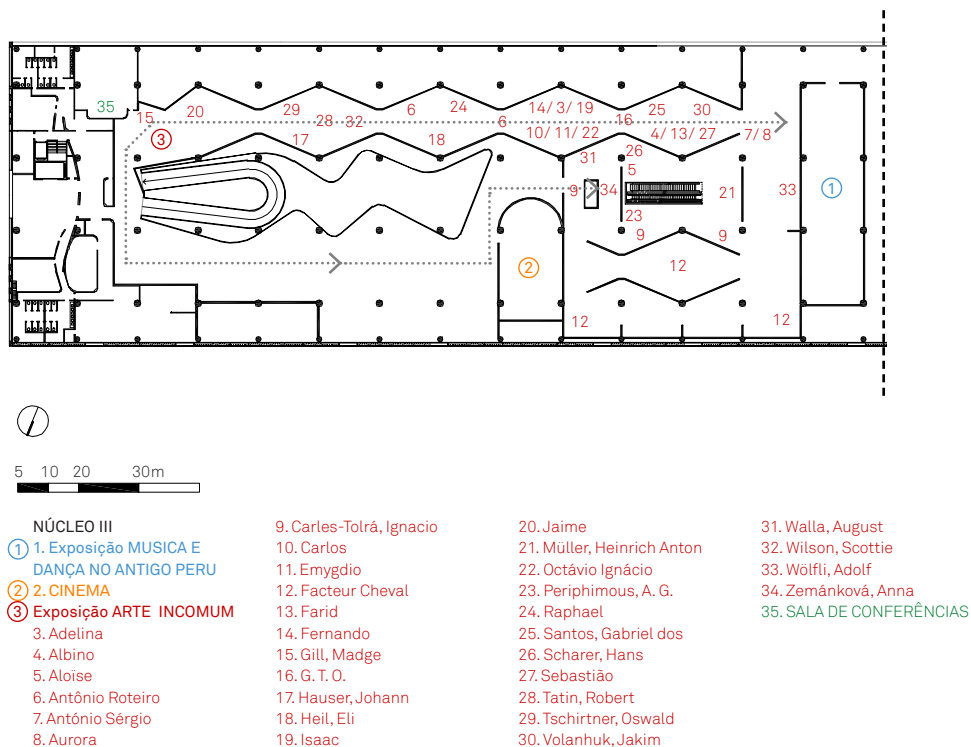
PLANTA DO TERCEIRO PAVIMENTO da exposição. Arte Incomum, Cinema e Núcleo 3.
